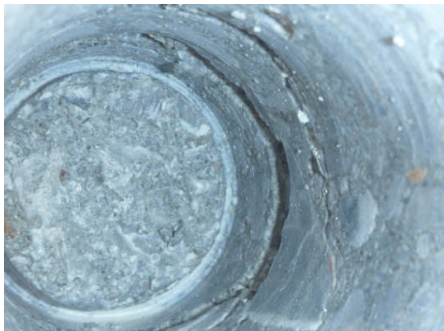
コア採取孔壁に確認されたひび割れ (瀬底大橋 P8 瀬底島側 EL+5.02m)
